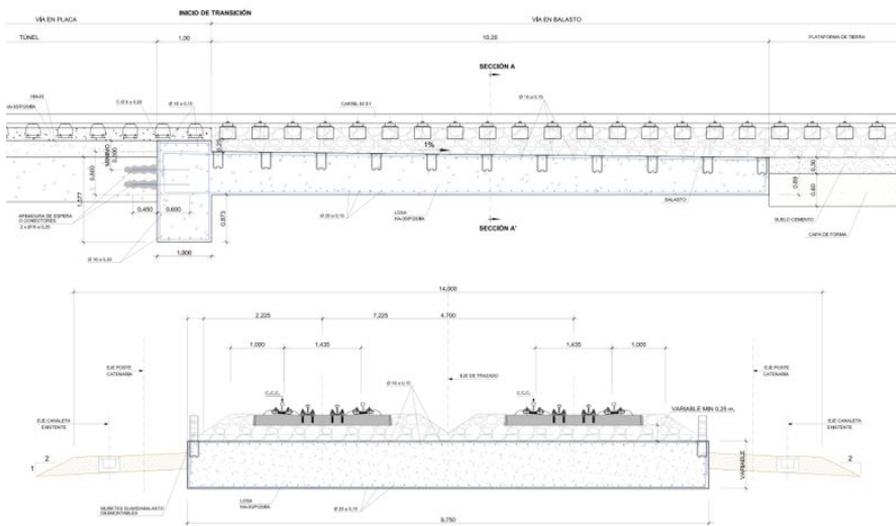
Transición placa-balasto en el sistema Rheda2000, (FUENTE: Instrucción General para la Redacción de Proyectos de Vía (ADIF))
